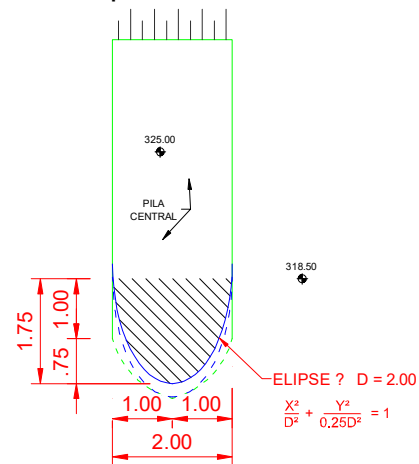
Perfil de las pilas centrales No. 5 y accesos laterales P5
